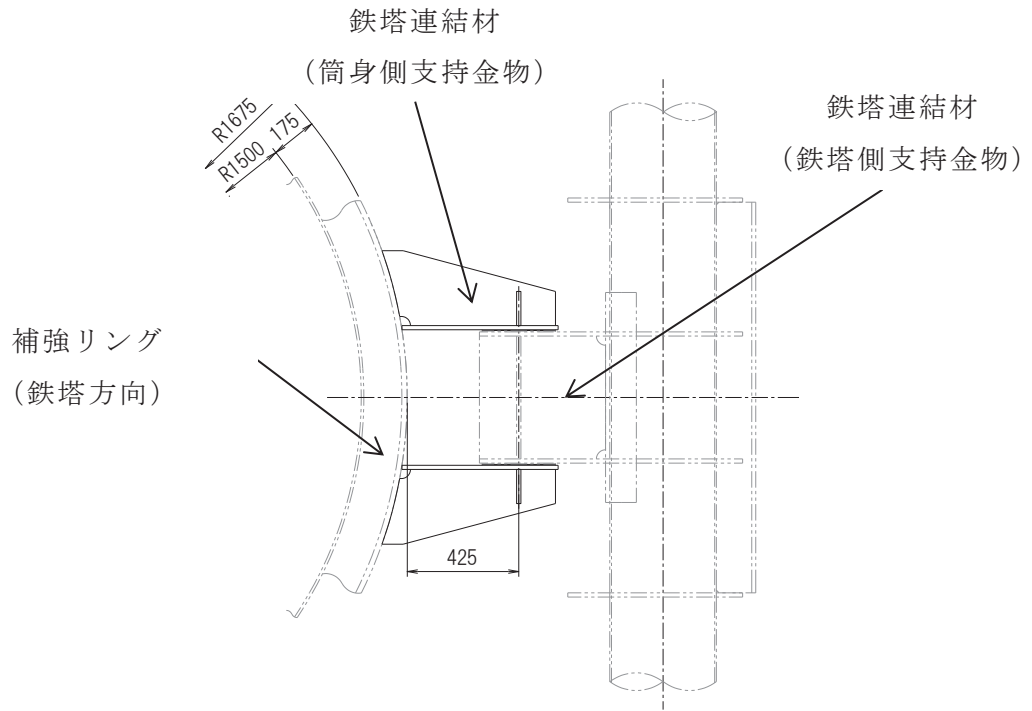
第 1 支持点, 第 2 支持点及び第 4 支持点部拡大図 (単位: mm)
